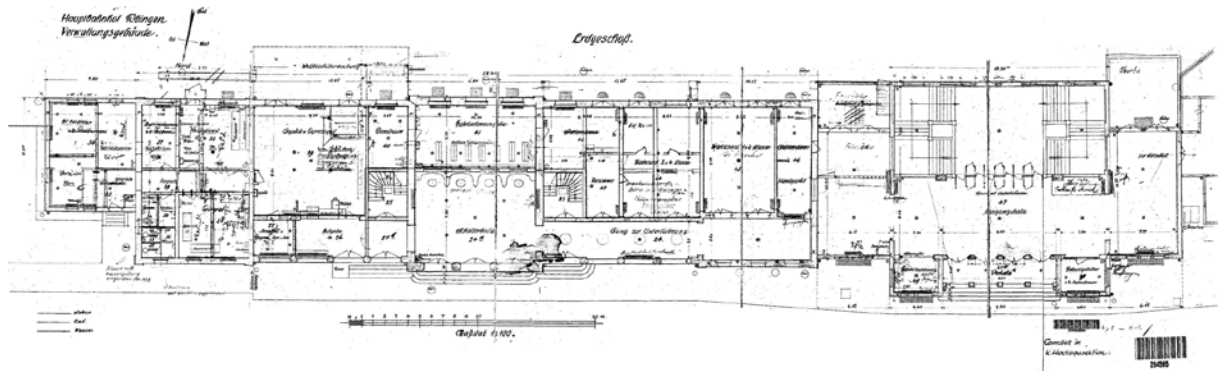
Grundriss Erdgeschoss 1914 (Quelle: Landesarchiv Baden-Wuerttemberg_Staatsarchiv_Ludwigsburg_K_412_IV_DO_14646_Bild_1_(2-1949713-1))
